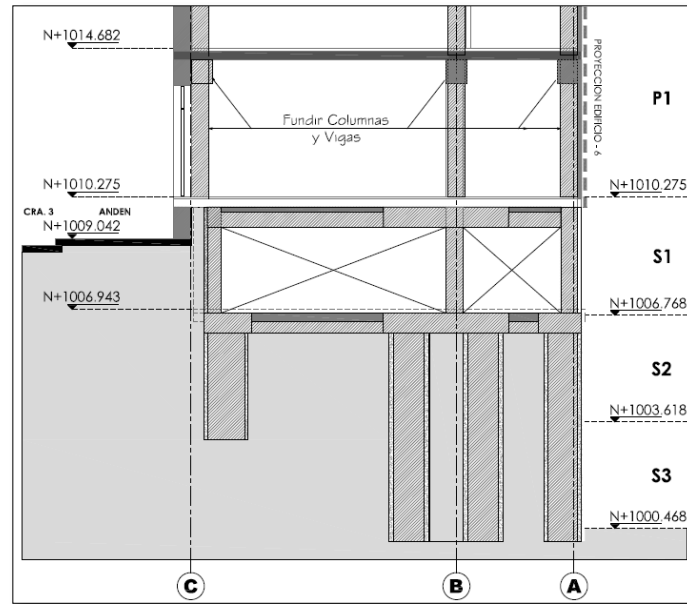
Sección Final Alternativa 1 –Columnas y vigas pisos superiores.
